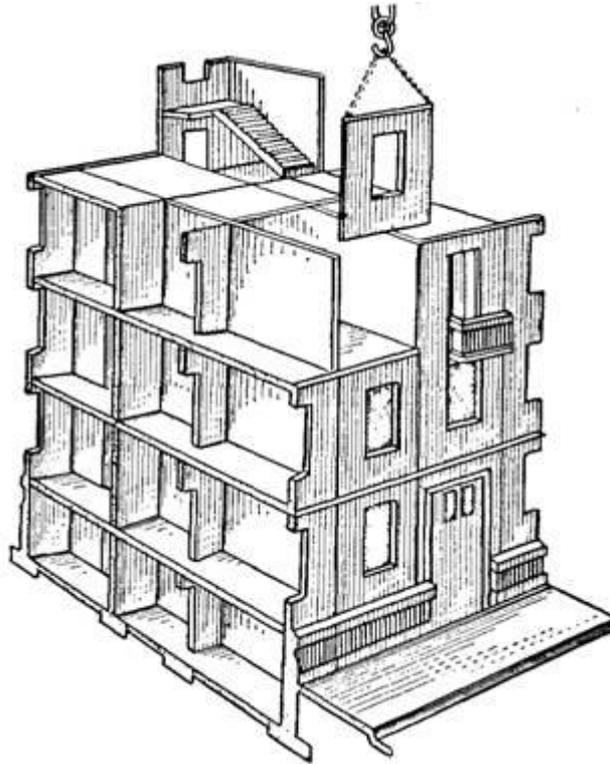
Схема безкаркасної великопанельної будівлі
